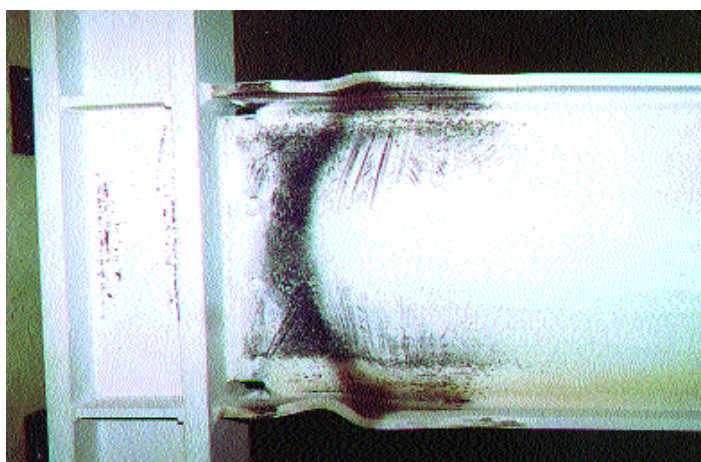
Modelo de viga RBS desarrollando articulación plástica en la sección reducida de la viga (Engelhardt et al. 1996).
